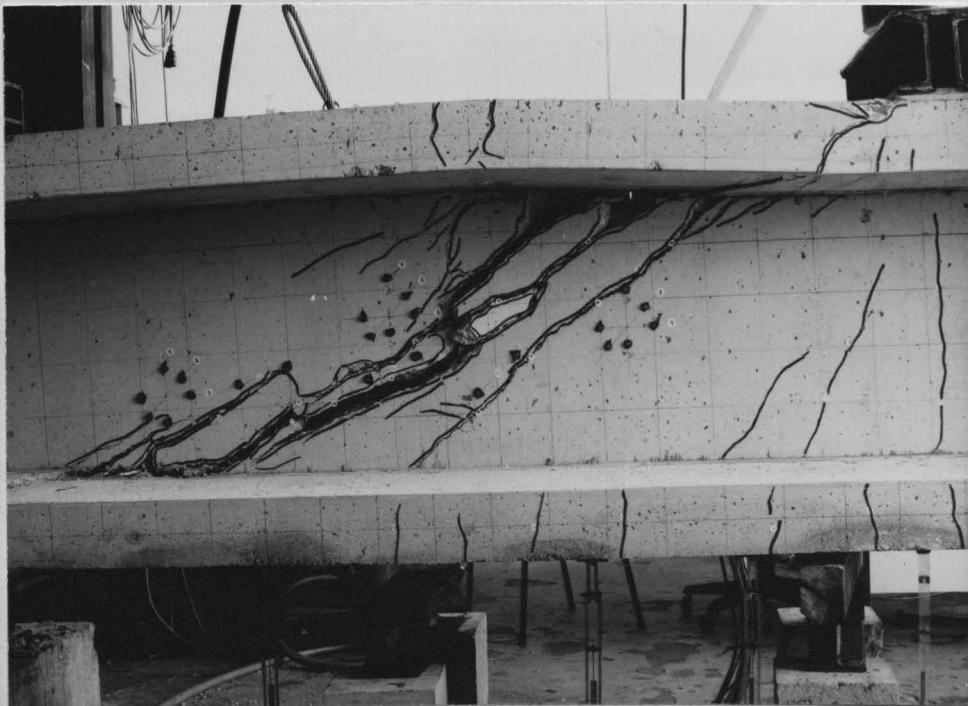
Druckbereich des Versuchsbalkens B1
